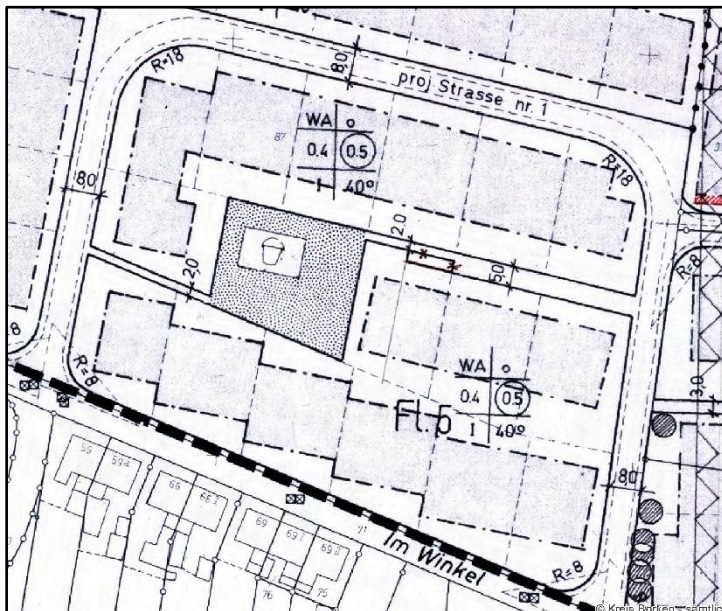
Auszug aus dem seit dem 18. November 1983 rechtsverbindlichen B-Plan 2-4
